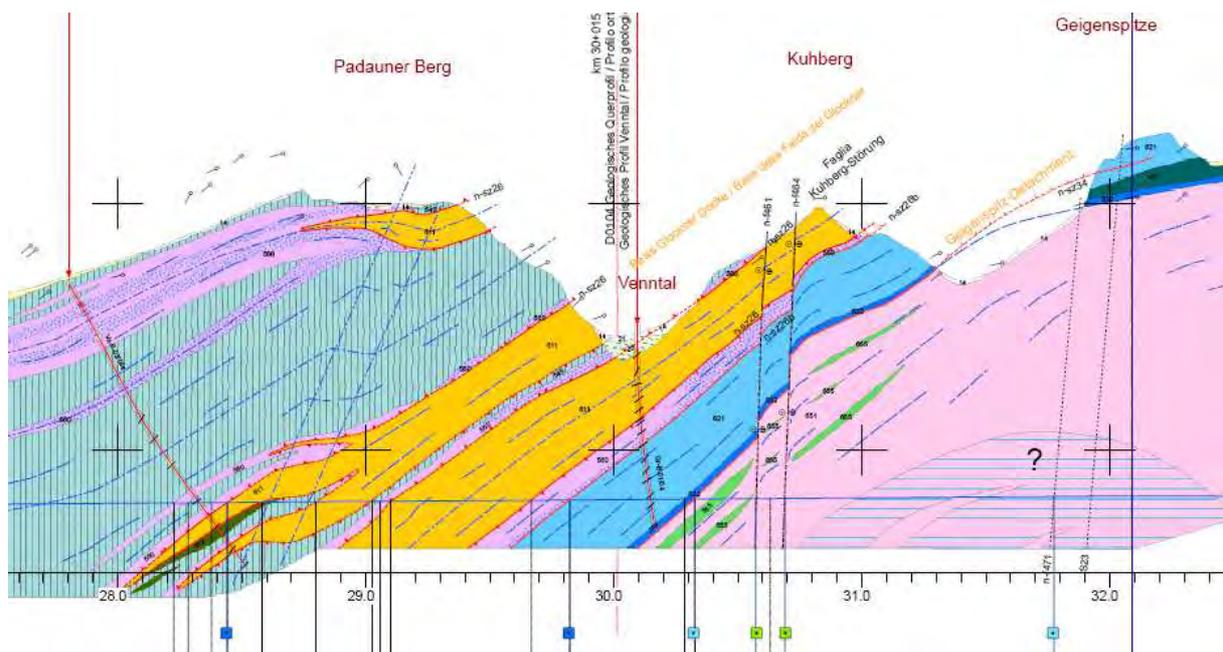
Querungsbereich des Brenner Basistunnels mit dem Venntal (Detailausschnitt aus D0154-00003); blaue horizontale Linie: Tunnelebene
